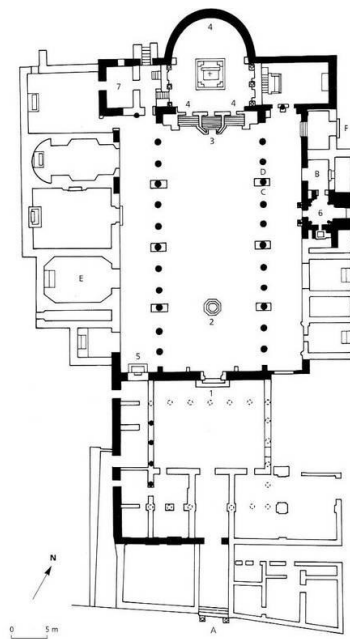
Igreja de Santa Maria in Cosmedin, Planta
